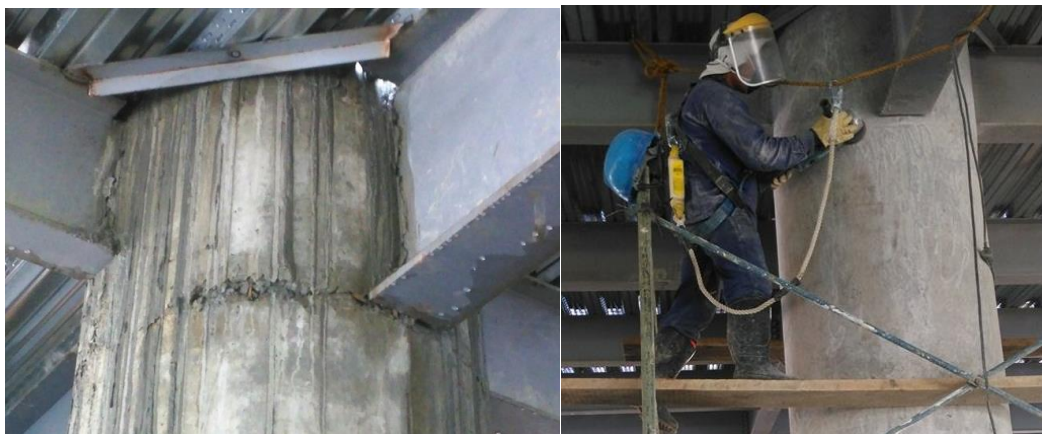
Rebaba de concreto en nudo de columna-Pulimiento entre nudo y cuerpo de columna. Fuente propia.
